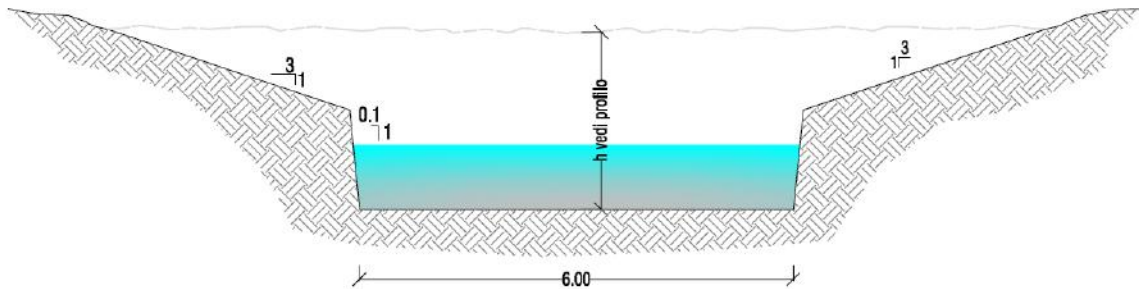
Sezione canale deviatore lama Scorbeto – primo tratto
